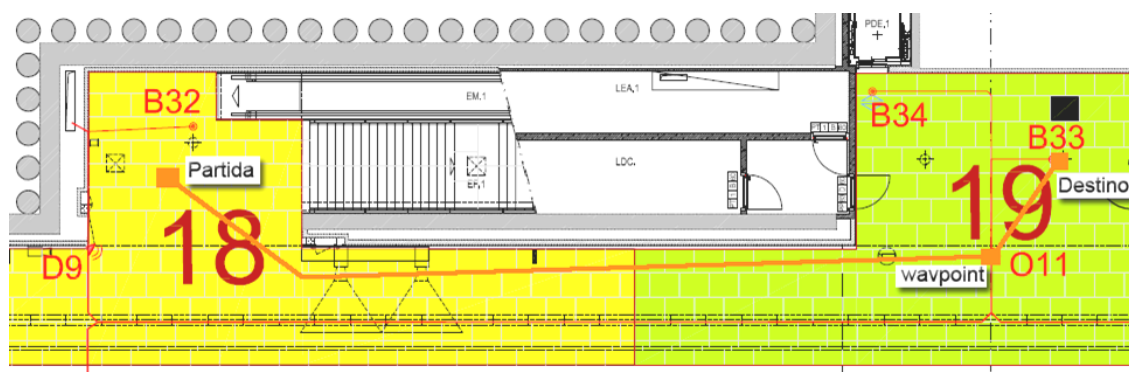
Pormenor da planta ilustrando um exemplo de encaminhamento
